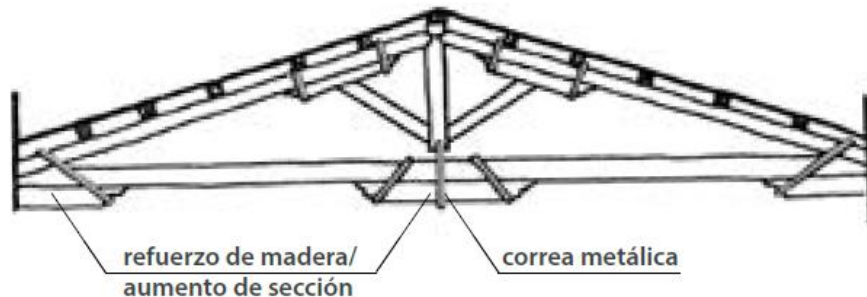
Armadura de madera por Vasari para la cubierta de la galería Uffizi.
